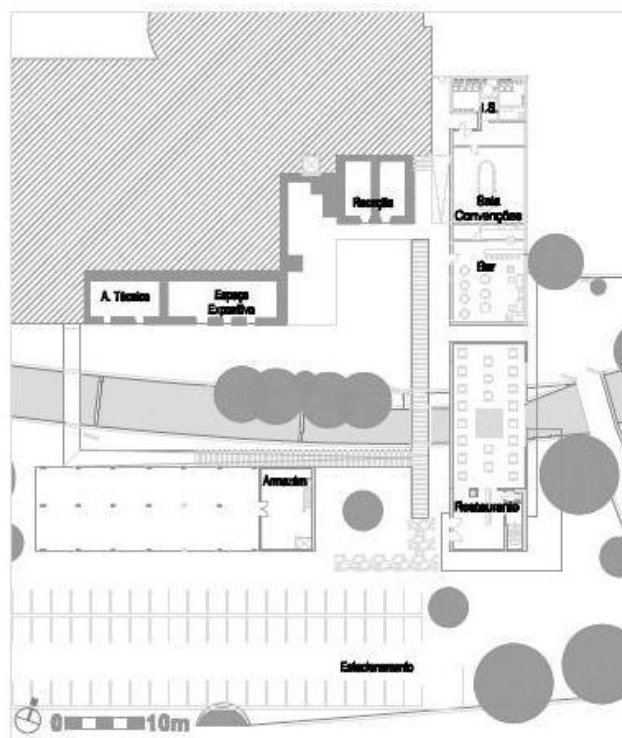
Planta da Proposta Piso 0. (Ver Anexo IV)
